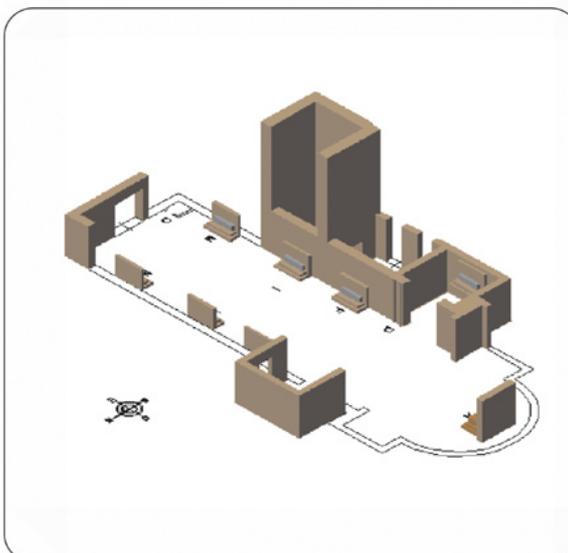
Pianta e modello tridimensionale dell'antica Chiesa Madre di Misterbianco.
